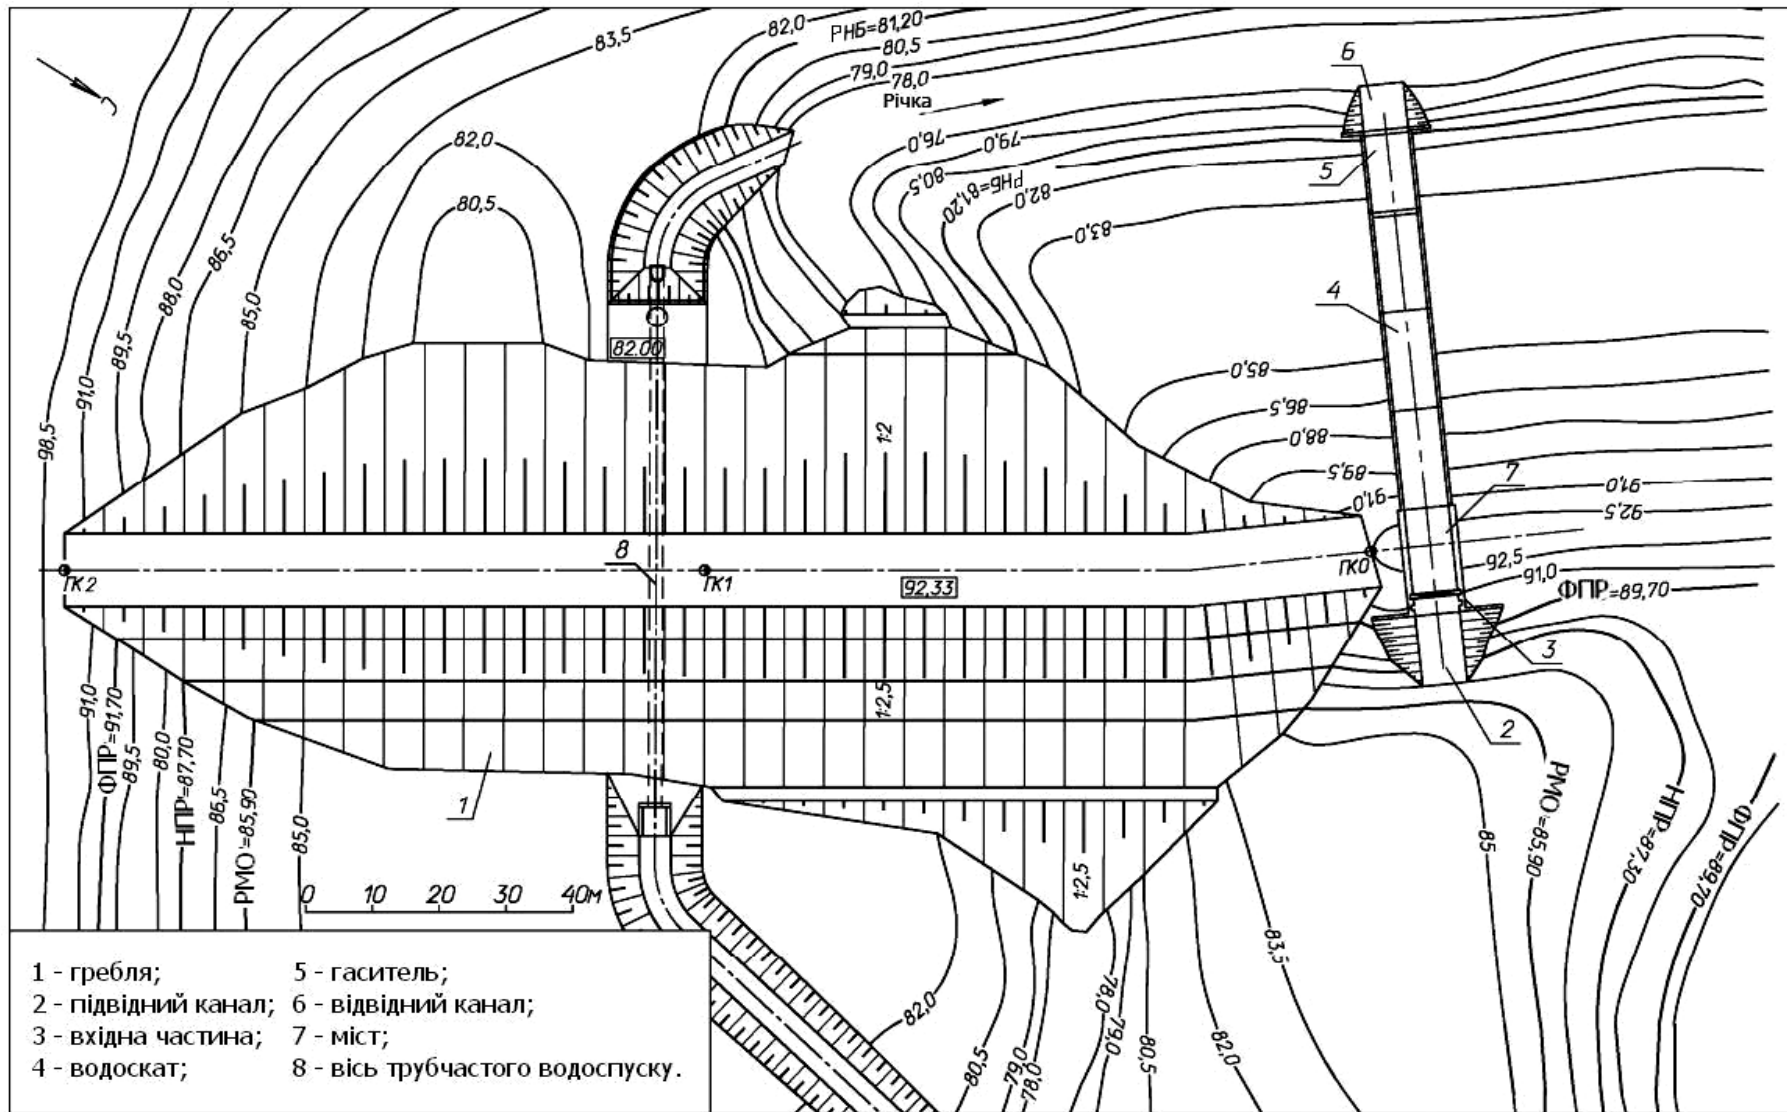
Генеральний план гідровузлу з береговим водоскидом й донним водоспуском
